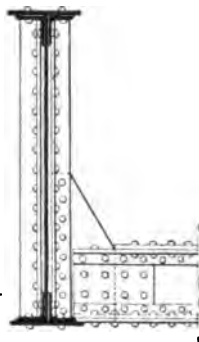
Assemblage de 2 poutres de hauteurs très différentes (gousset réuni à l'âme par couvre-joints).
